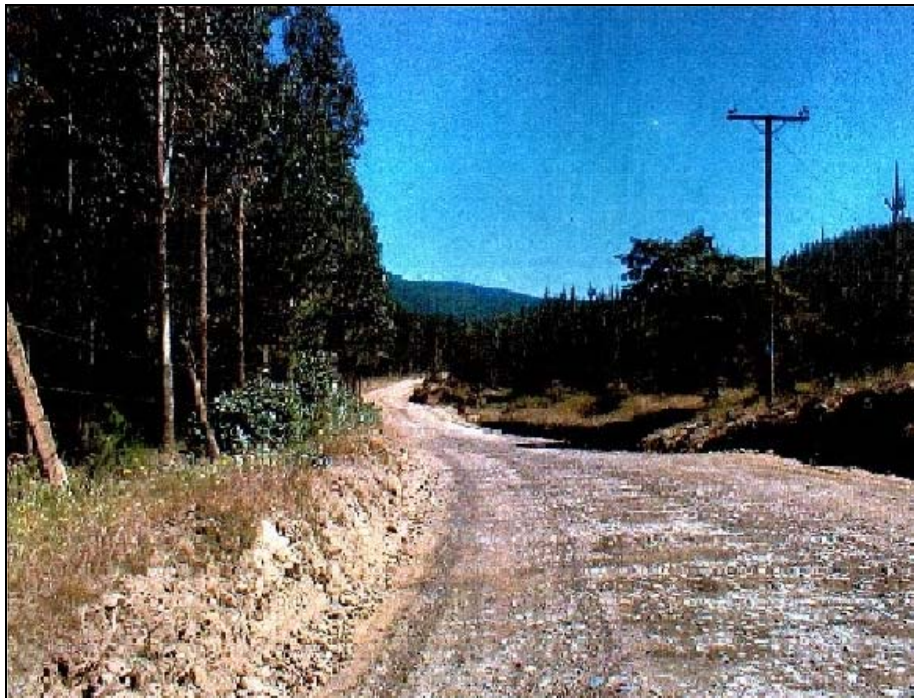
Término de la Ruta Situación Sin Proyecto, sector Empedrado
